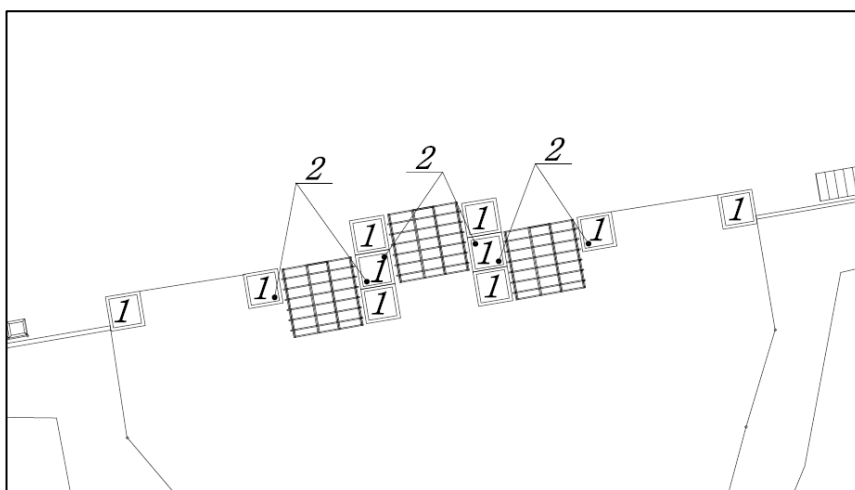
Фрагмент генплана 2, схема посадки растений для входной зоны
